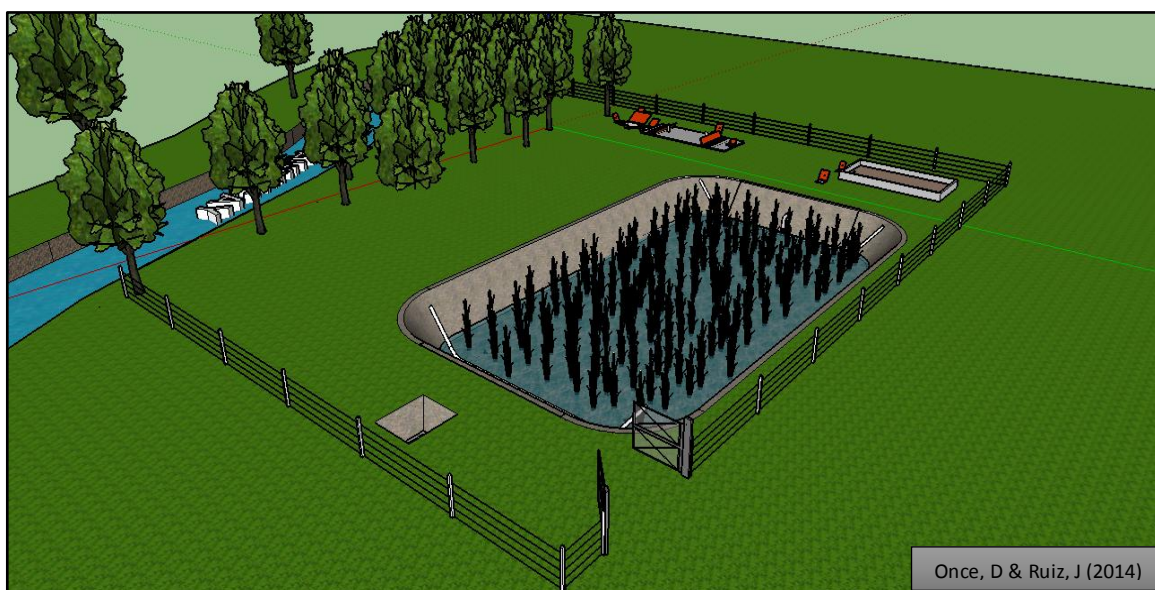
Vista preliminar, PTAR Soldados
